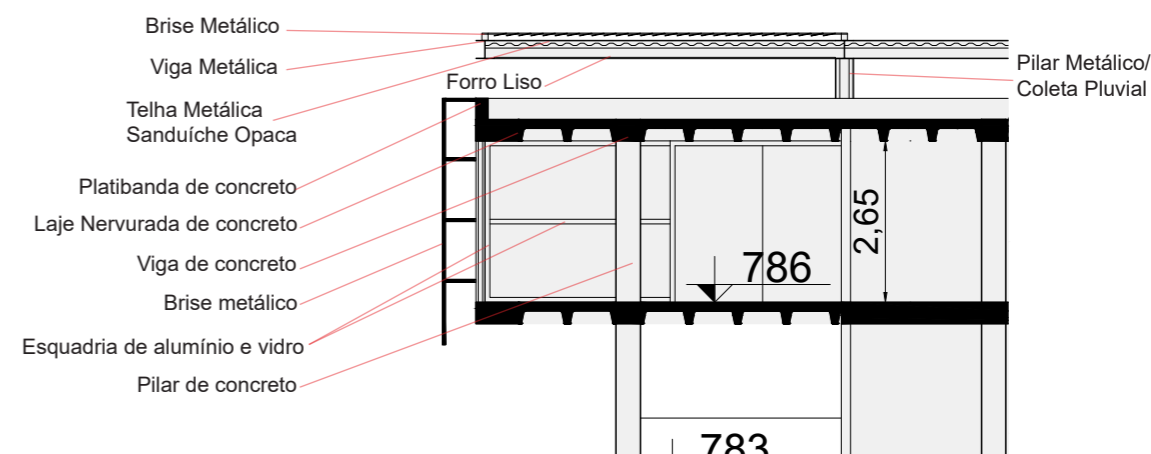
Detalhe estrutural em corte da edificação da UFFS. Destaque para a modulação tanto da laje nervurada quanto dos pilares/vigas, posição do brise e da cobertura metálica independente, mais ao fundo.
